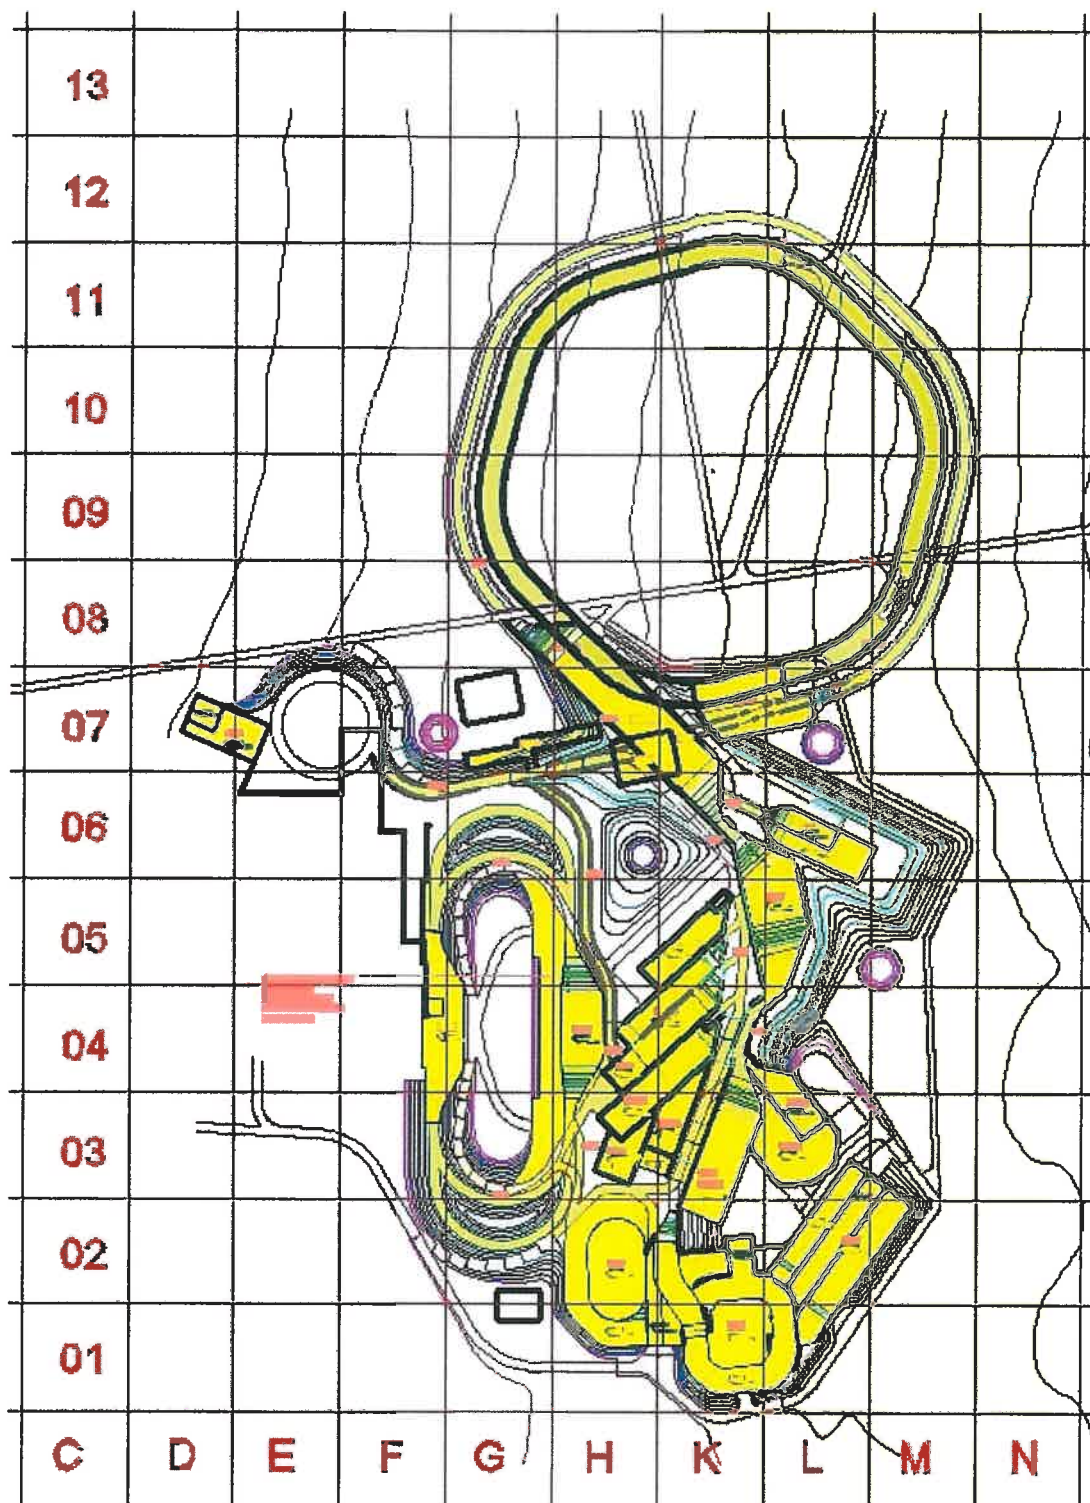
Lage der Gebäude und Höhe der Geländeauffüllung nach [U19]
